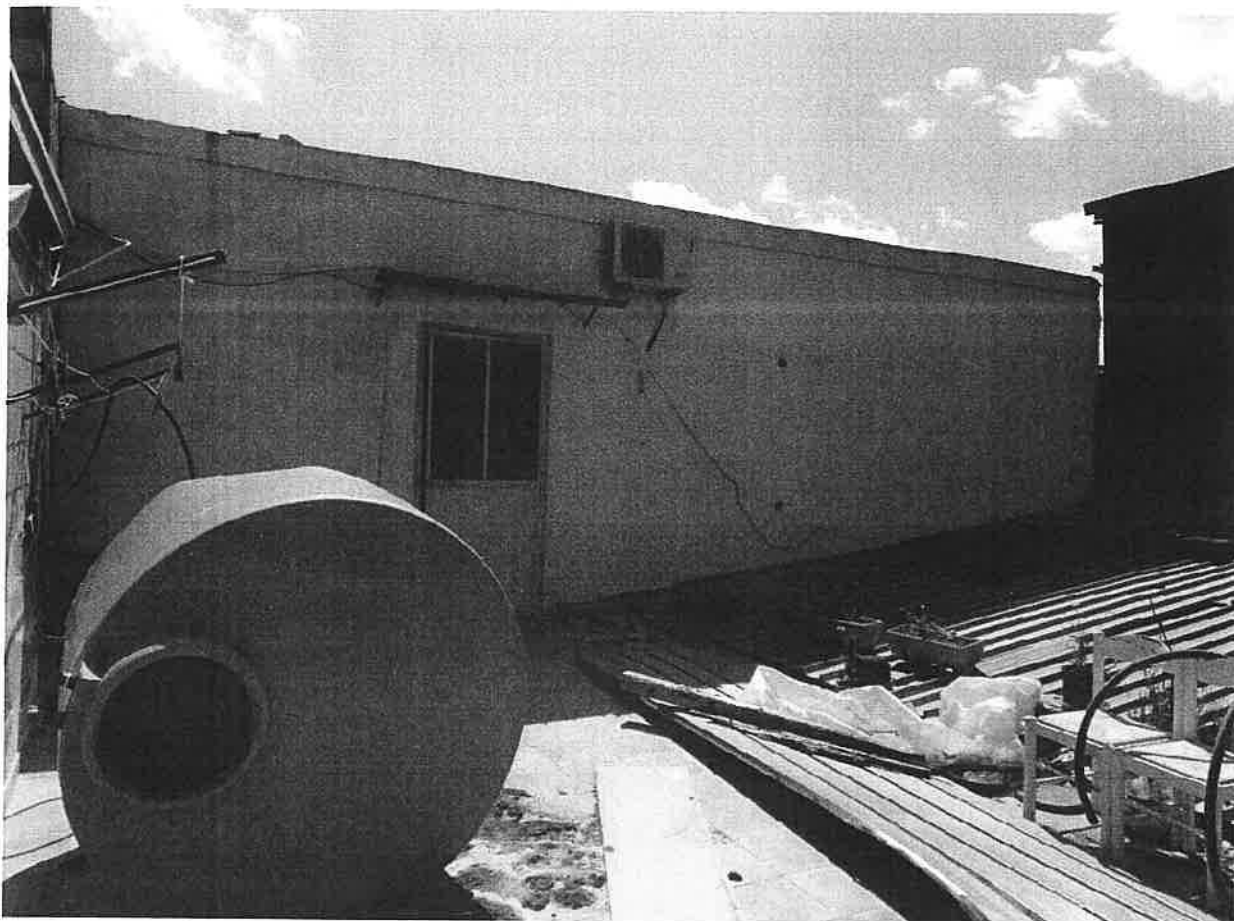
Prospetto anteriore dell'alloggio (primo piano)
